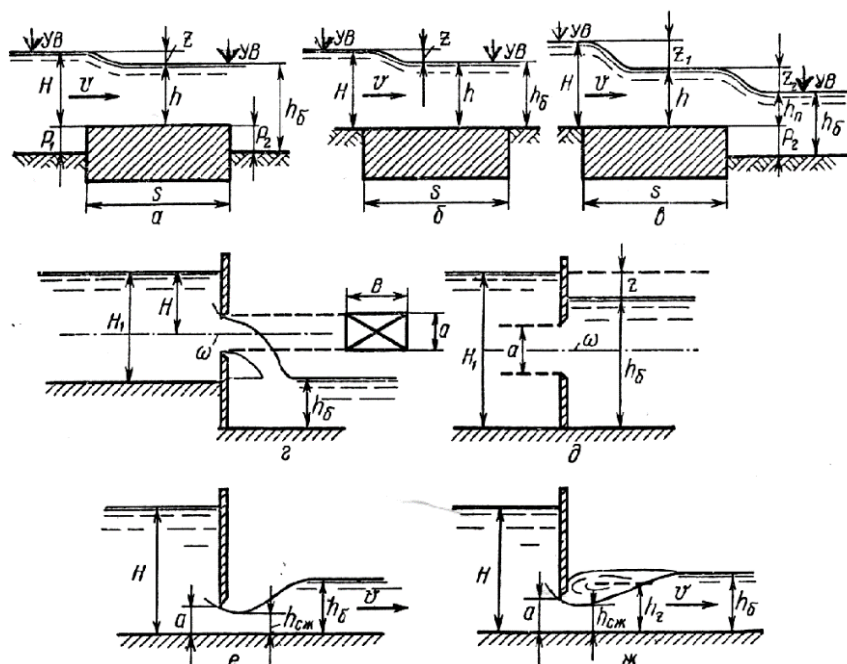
Расчетные гидравлические схемы открытых шлюзов-регуляторов: а – водослив с приподнятым широким порогом; б – донный водослив с широким порогом с подтопленным истечением; в – водослив с широким порогом с неподтопленным истечением; г – истечение через большие неподтопленные отверстия; д – истечение через большие затопленные отверстия; е – выпуск воды из-под затвора с неподтопленным истечением; ж – выпуск воды из-под затвора с подтопленным истечением.
